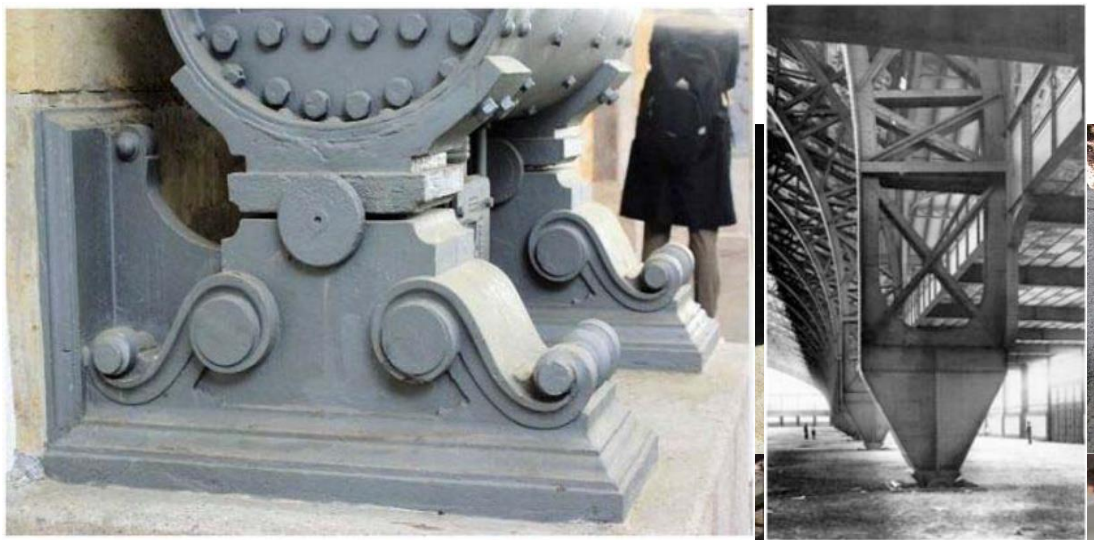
Fotografías de conexiones rígidas y articuladas. Fuente: Alacero, Conexiones base-columna
